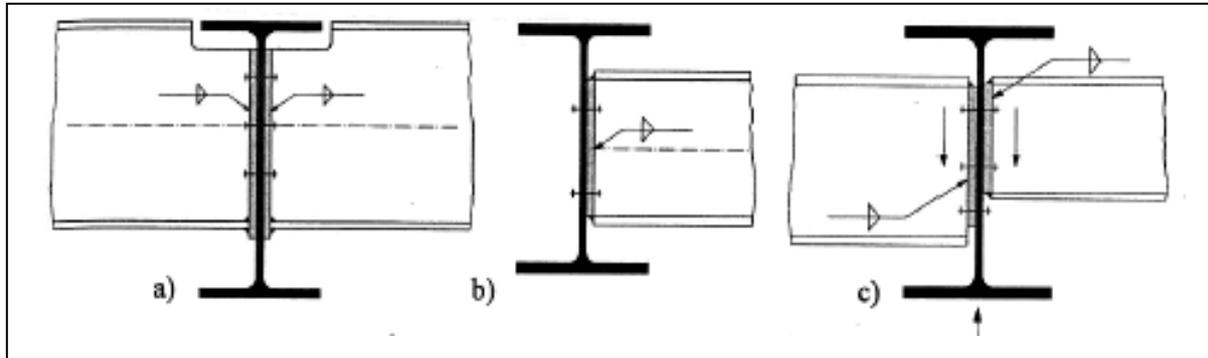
Gelenkiger Stirnplattenanschluss, Ausführungsformen, aus [25]
